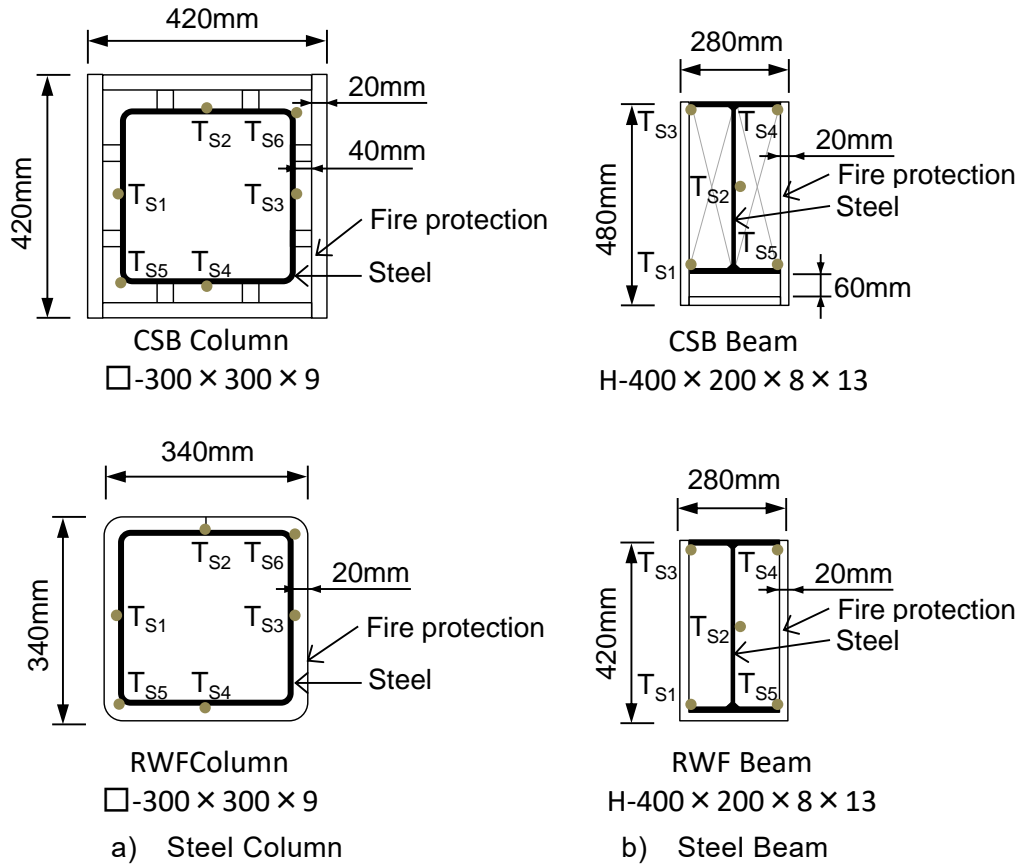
試験体の断面状況と測定位置(単位: mm)
